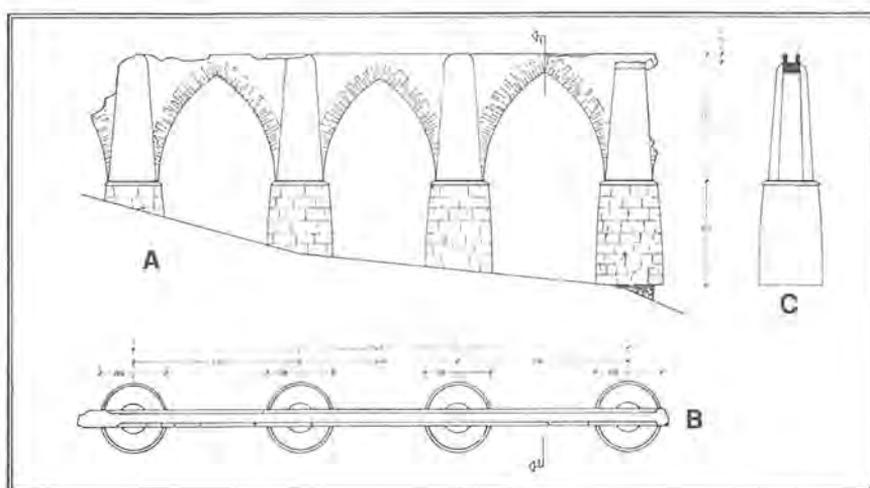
Planta, alzado y sección de acueducto de Puça (Varela Botella, 1983: 30).
